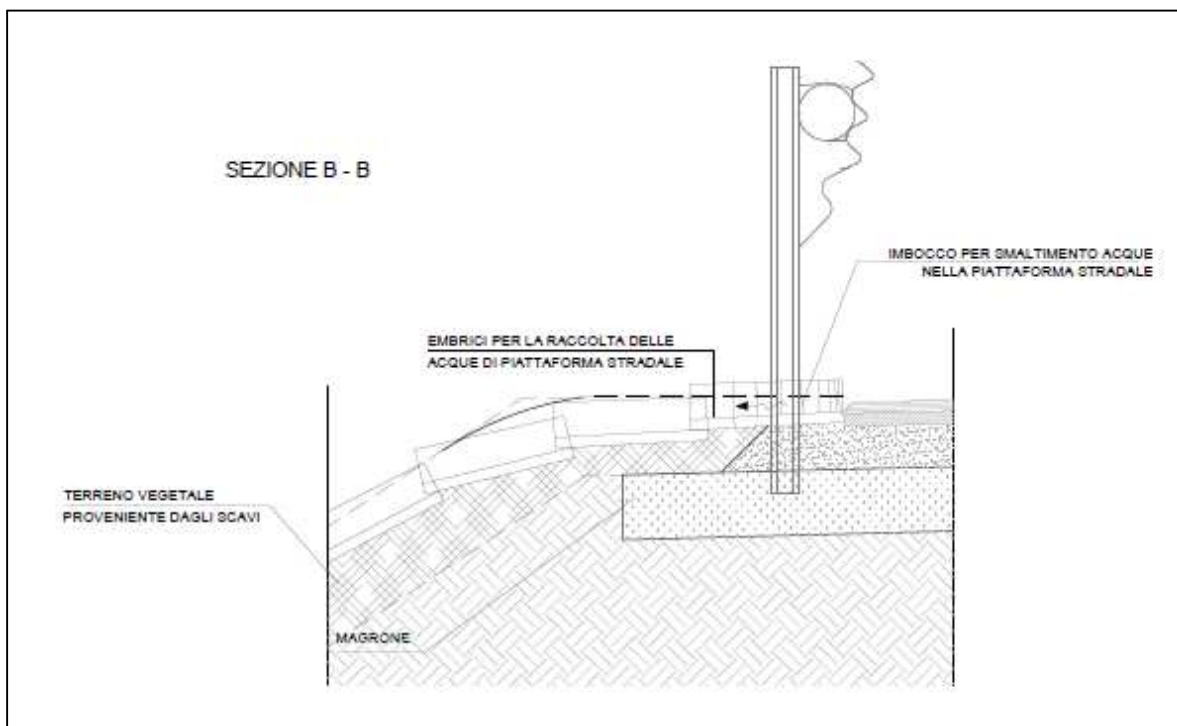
Schema del drenaggio per sezione in rilevato - Embrici
